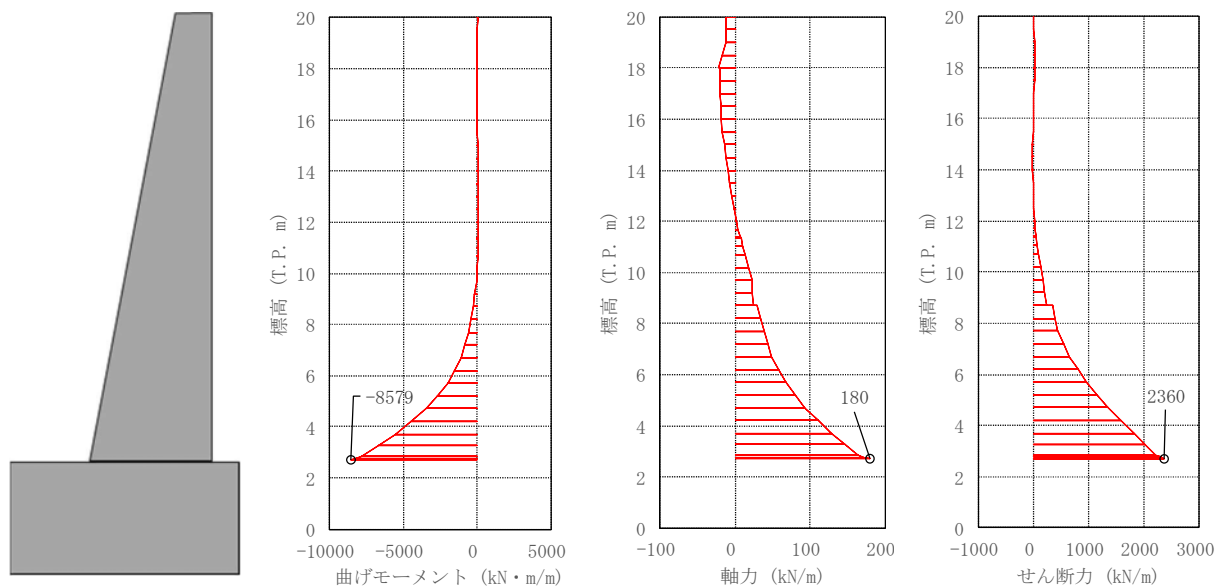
(1) 鉄筋コンクリート防潮壁においてコンクリートの曲げ軸力照査結果が最も厳しい断面力（津波時：基準津波時）
